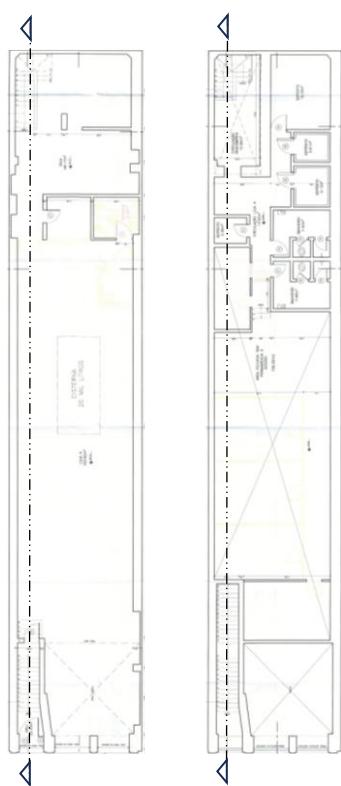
Planta baixa do segundo pavimento e do patamar técnico (pavimento dividido)
